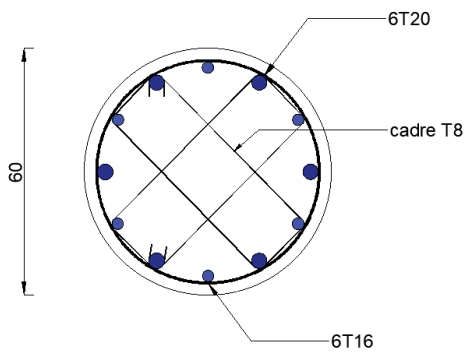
schéma de ferrailage des poteaux circulaires de RDC et 1^{er} étage
